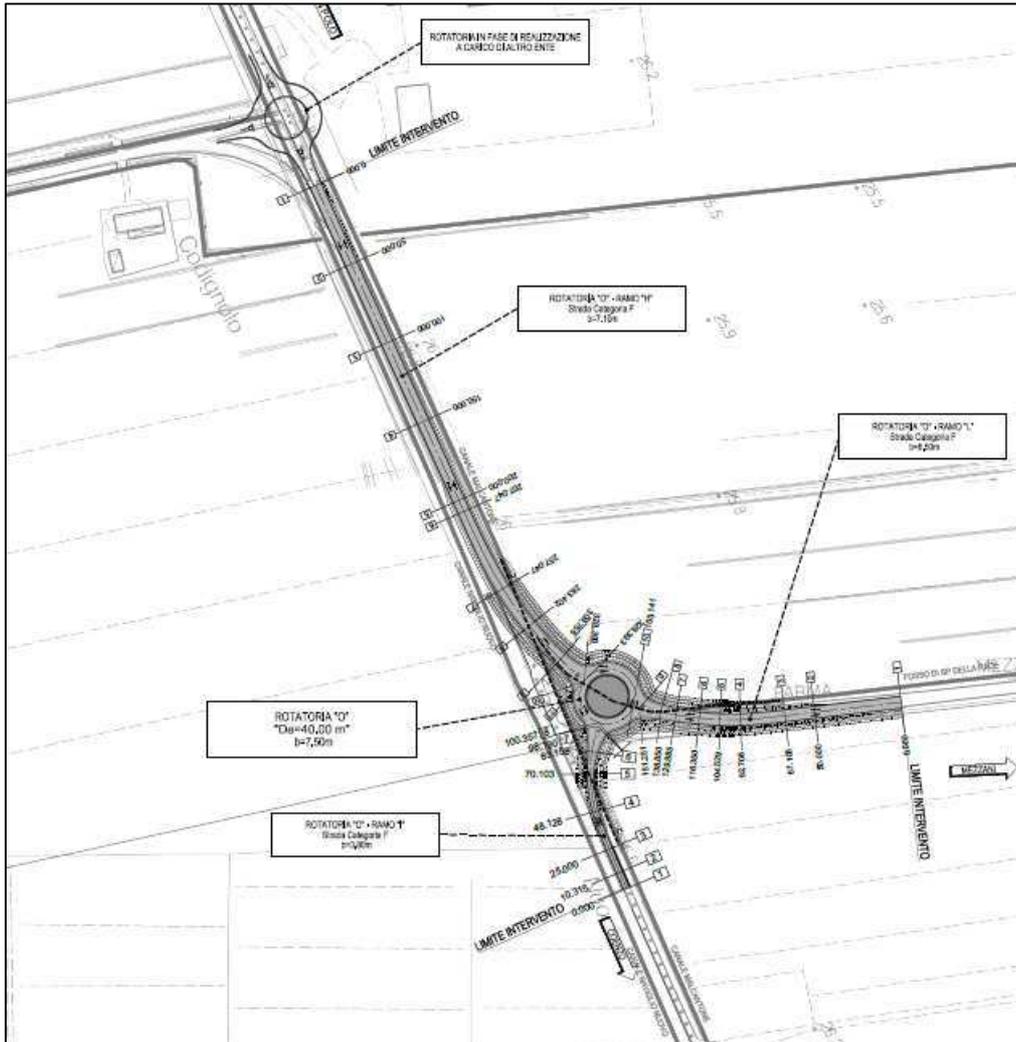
Planimetria di Progetto – Tratto C - Opera 1PR
